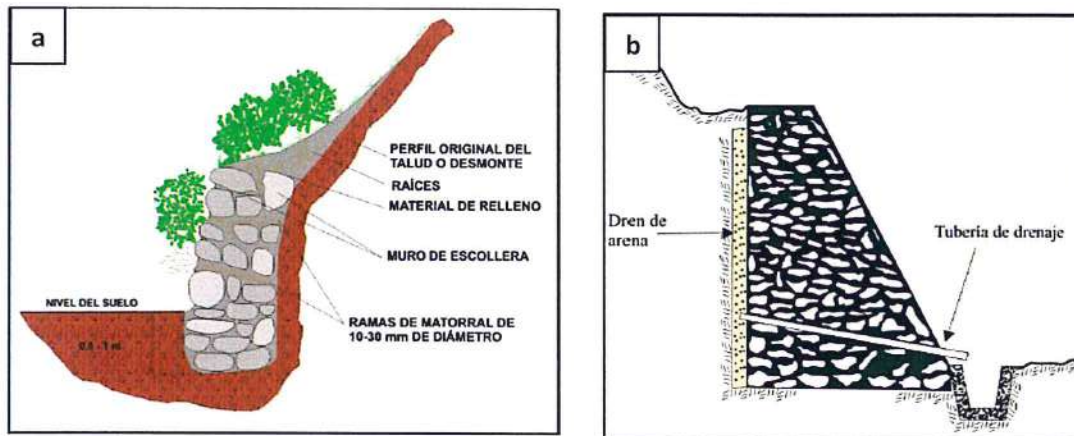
a) Muro de gravedad de piedra seca. b) Muros de gravedad de piedra argamasada.
